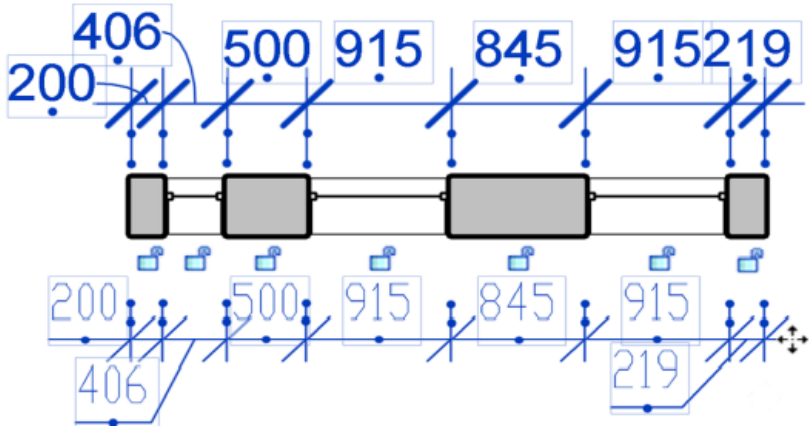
Розмірний ланцюжок - стандартний і новий тип / стиль. Керуючі вузлики і значки блокування
